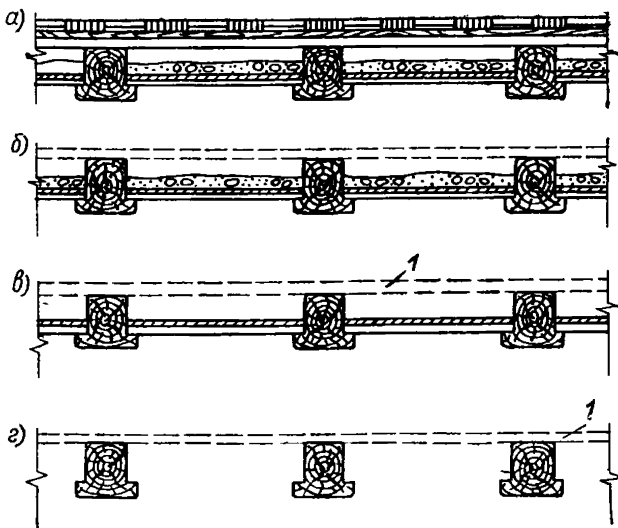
Последовательность разборки элементов междуэтажного перекрытия
